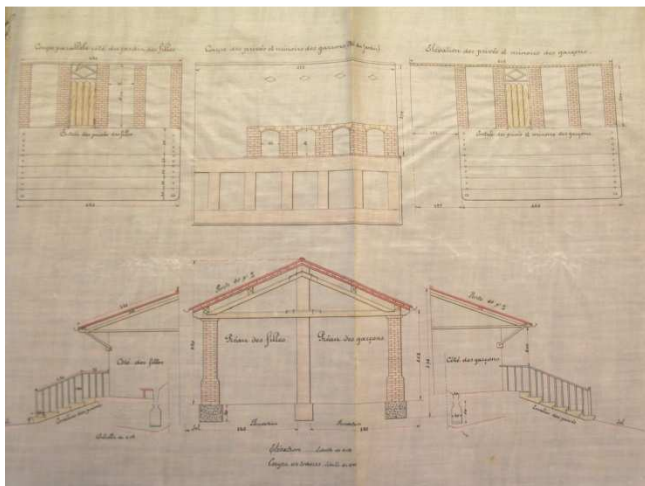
Projet de construction d'un groupe scolaire laïque, élévations sud.
